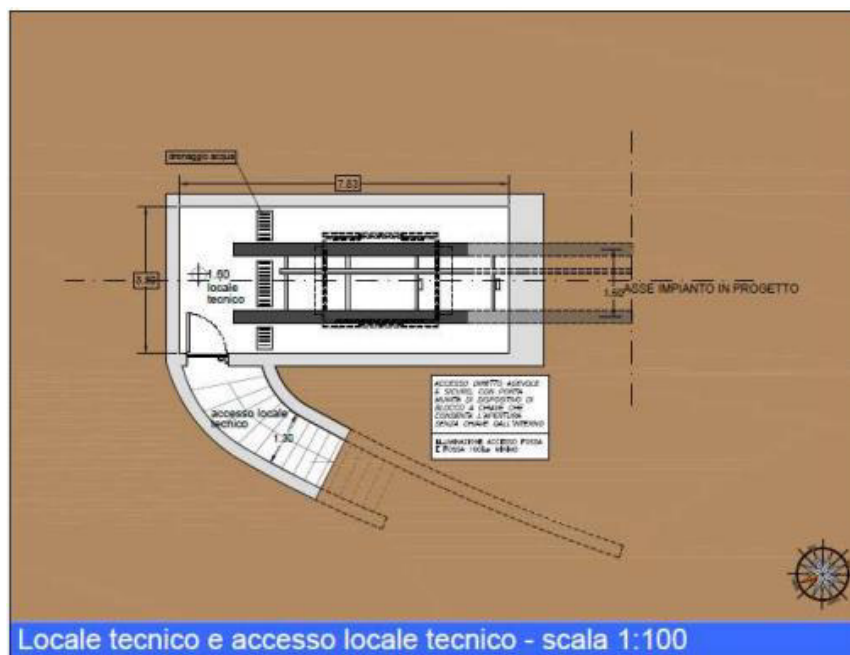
Locale tecnico e accesso al locale tecnico. Scala 1:100.
